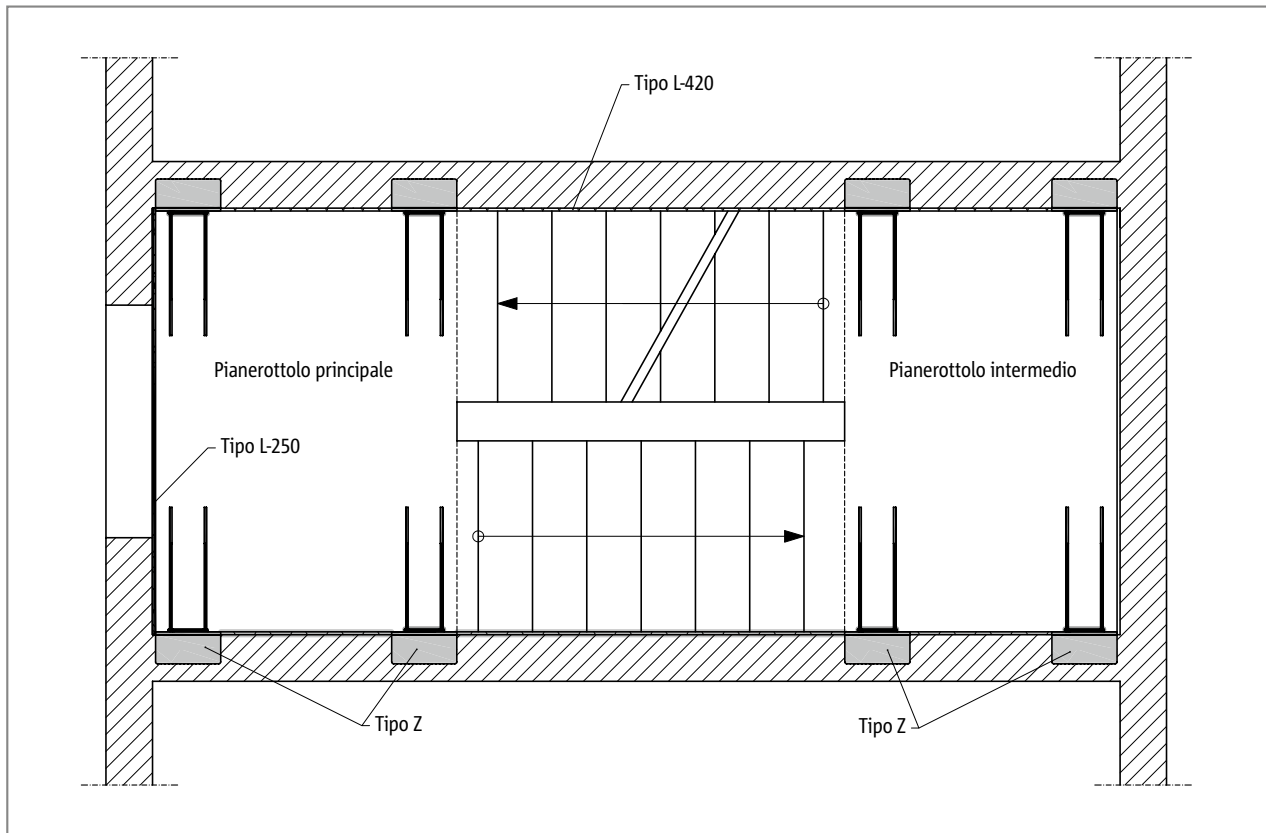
Schöck Tronsole® tipo Z, disposizione dell'elemento nella pianta
